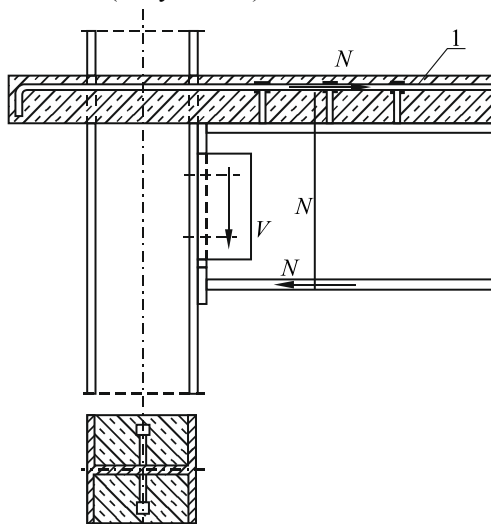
Расчетная схема сталежелезобетонного перекрытия
